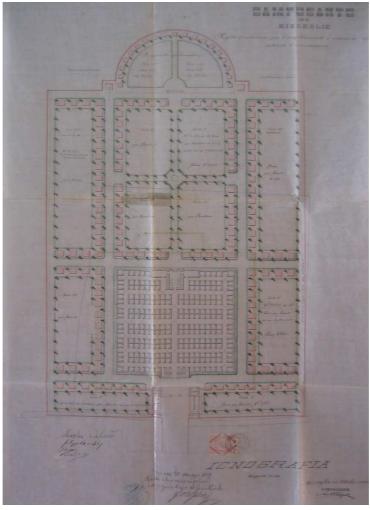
Planimetria di progetto dell'Arch. Mauro Albrizio (1888)
